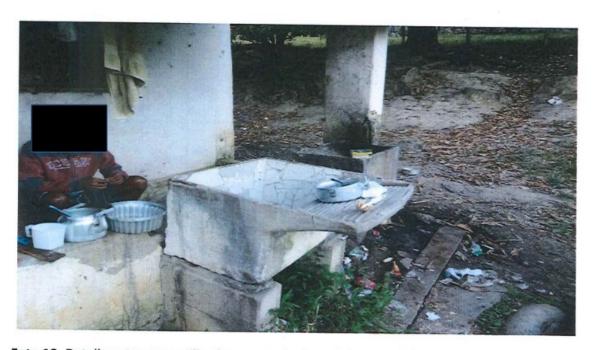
Detalhes: tanques utilizados como pia de cozinha e também para lavar roupas
